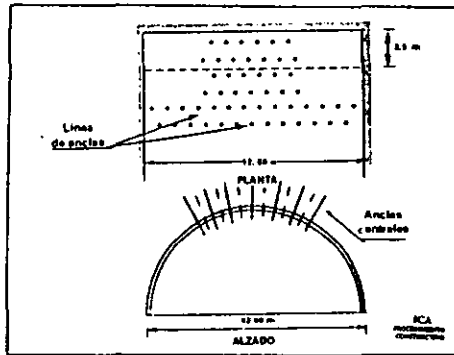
Anclaje central utilizando elementos de 1" \varnothing x 4.22 m.
